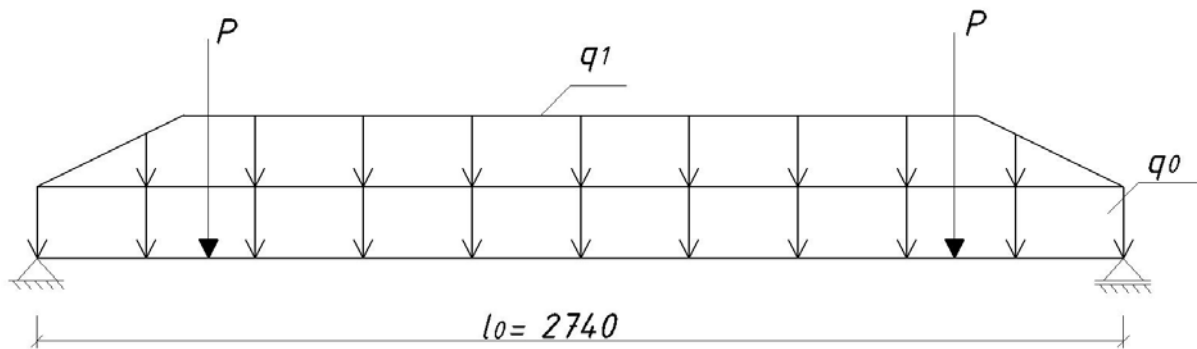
Розрахункова схема лобової балки сходового маршу
